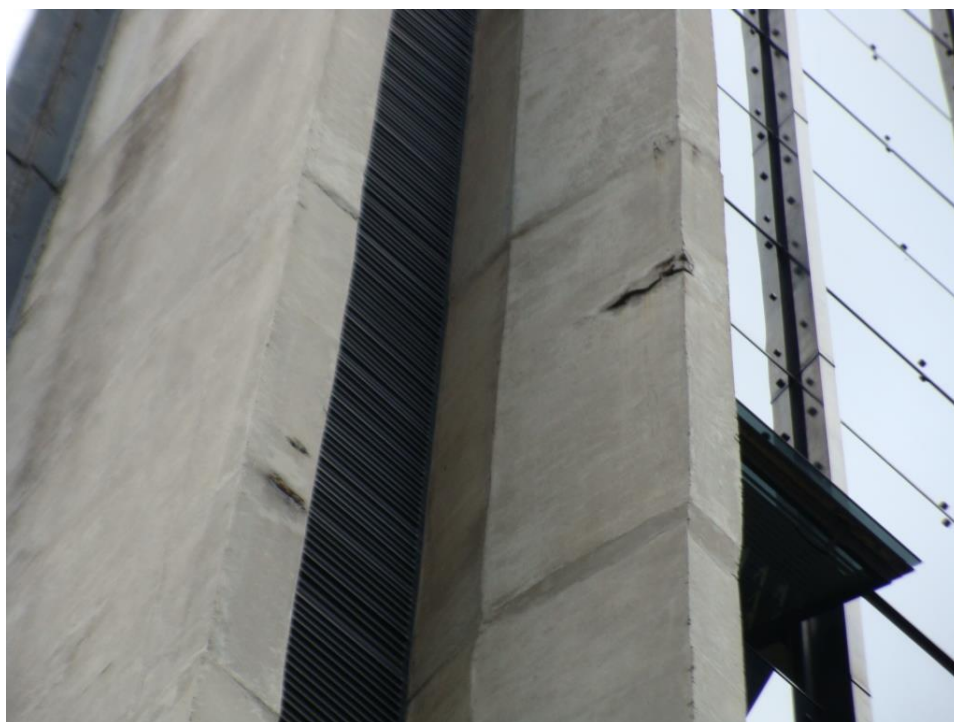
Armadura exposta pilar P11 (5º pavimento) (02/03/2021)
